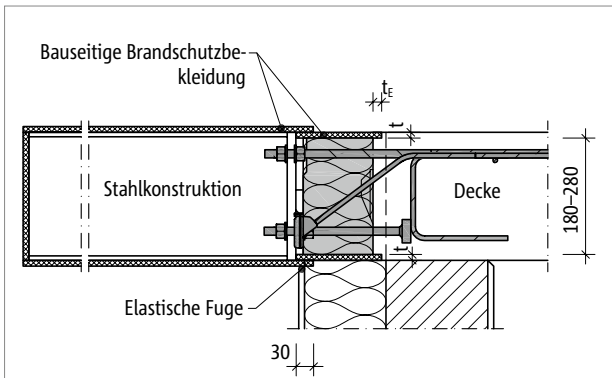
Schöck Isokorb® XT Typ SK: Bauseitige Brandschutzbekleidung für den Isokorb® und die Stahlkonstruktion; Schnitt
